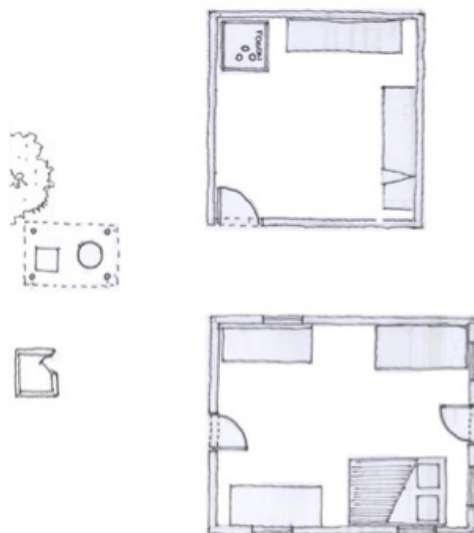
14. Planta arquitectónica de vivienda rural en La Tinta. Fuente: UR-PHED
